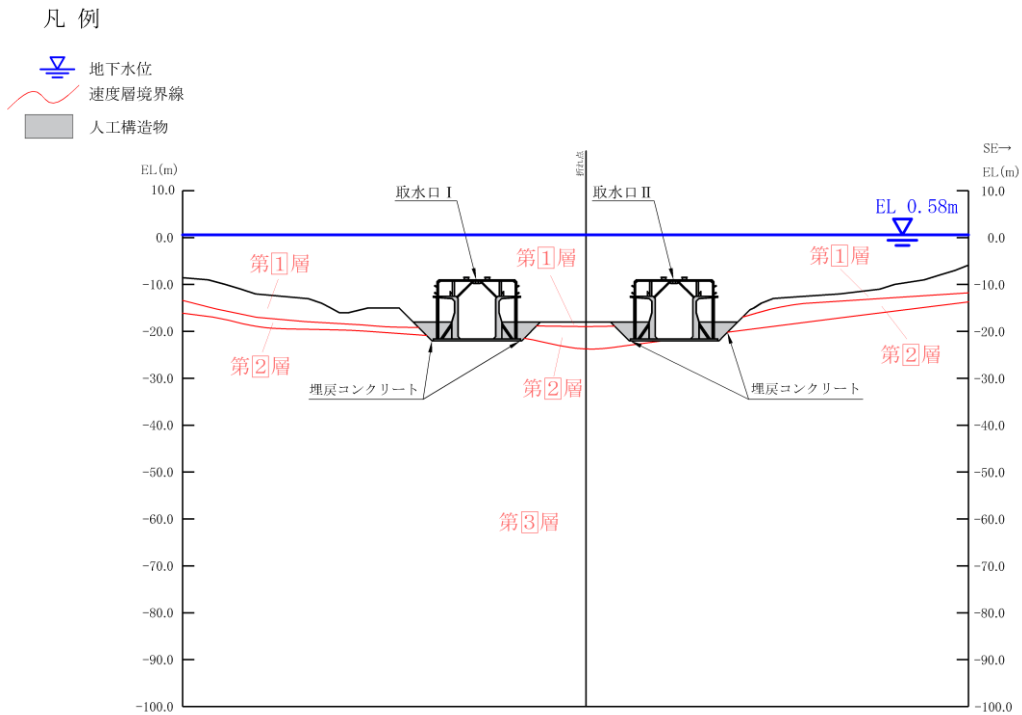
(6) 取水口 地質断面図 (②全応力解析)
